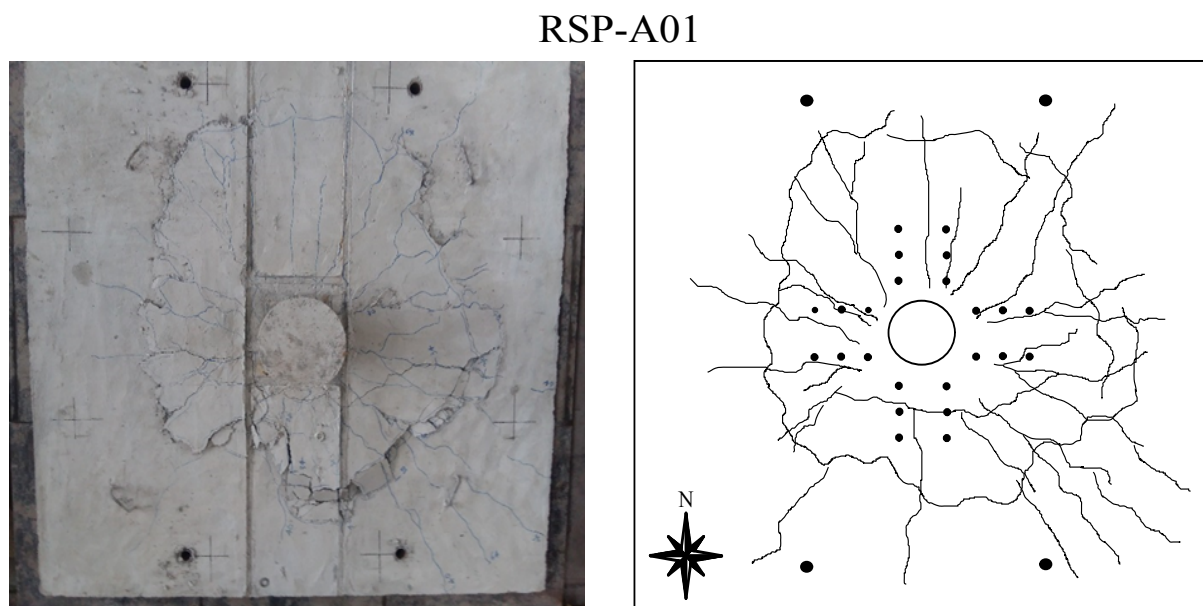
Mapa de fissuração - Laje RSP-A01
